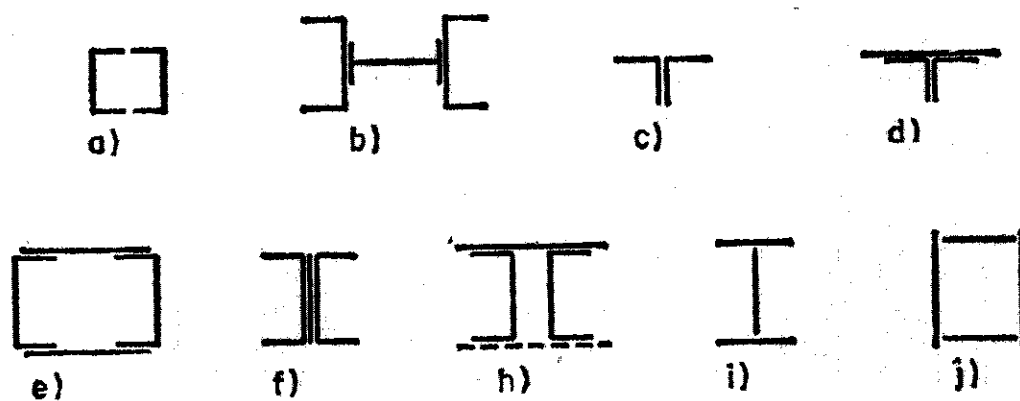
Ejemplos de piezas simples construidas por perfiles y/o chapas yuxtapuestas
